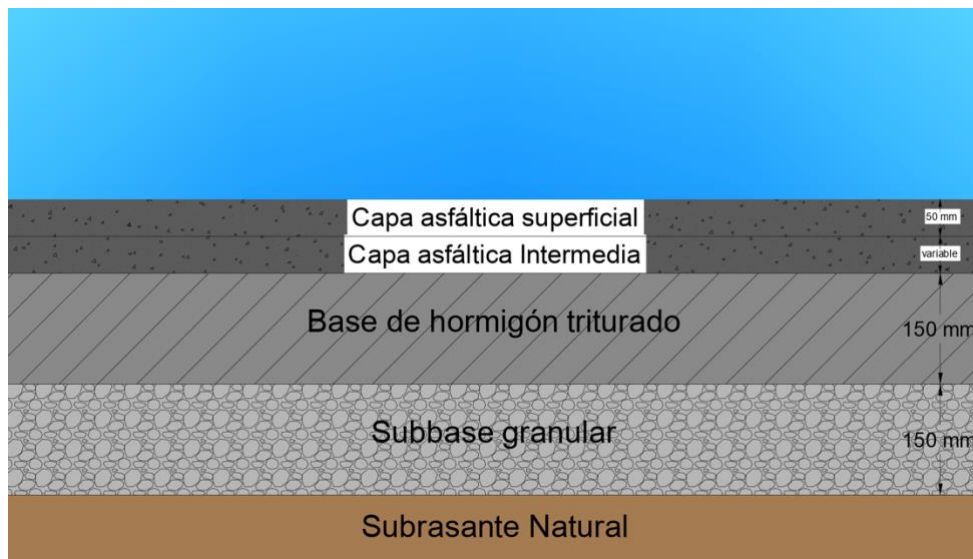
Esquema de estructuración final para rehabilitación de pavimento.
